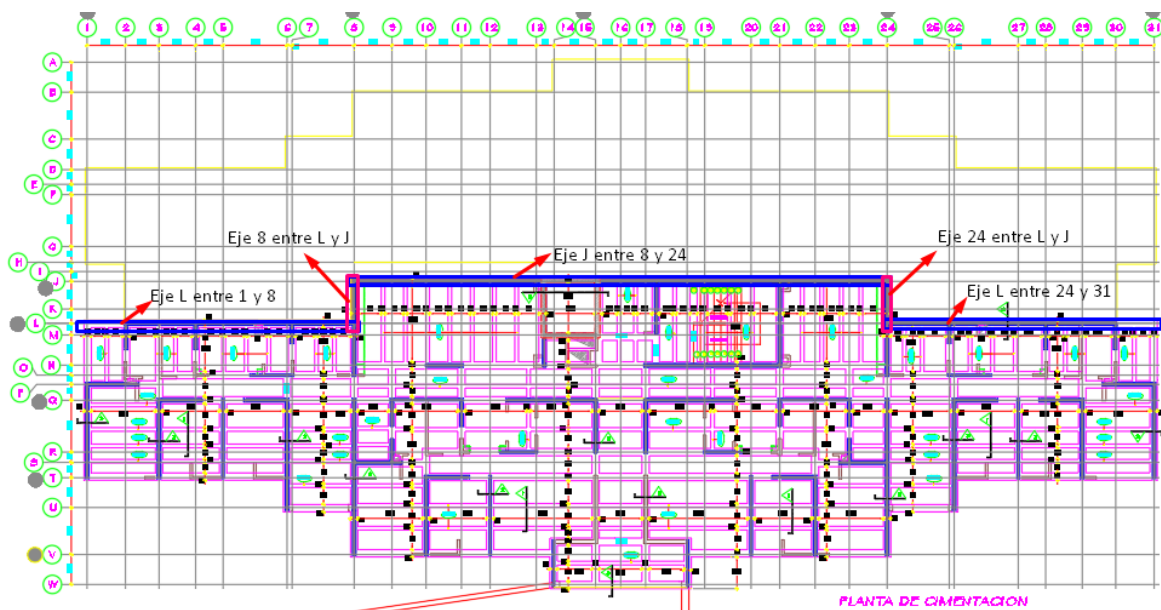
Planta de cimentación nivel 0.0 torre C.
